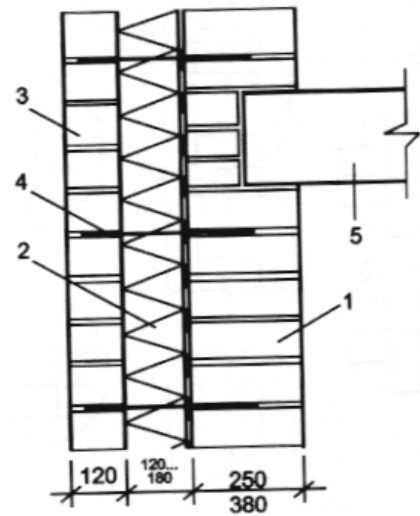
Стена с облицовочным самонесущим слоем из кирпича:
